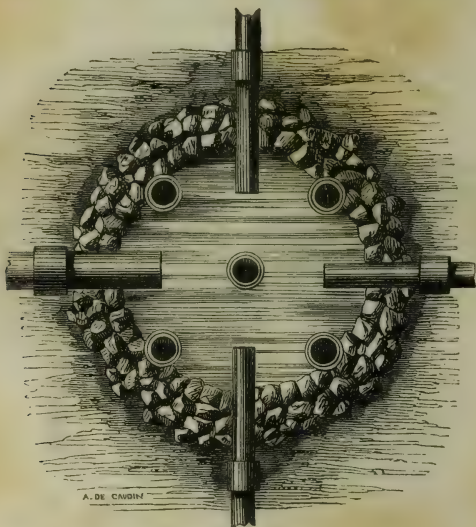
Plan du drainage vertical au niveau du tuyau d'écoulement.
